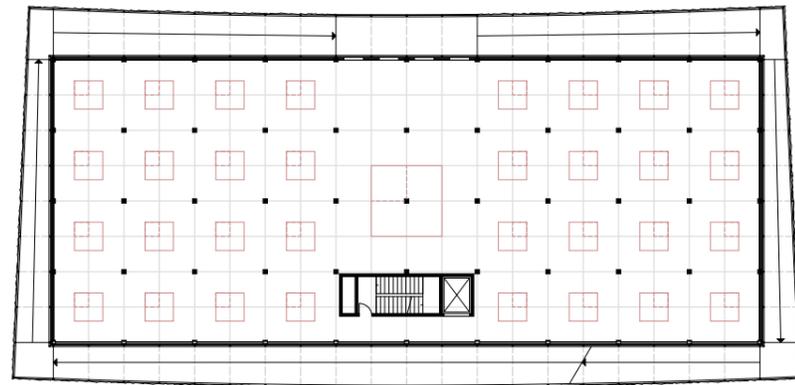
Darstellung „überlappende Eindrücke“, Berlin
